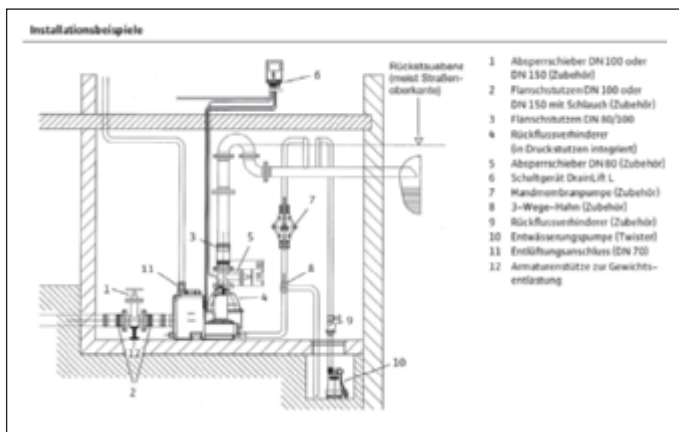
Darstellung einer Installation mit Abwasserhebeanlage zur Entwässerung eines Objekts unterhalb der Rückstauenebene.
